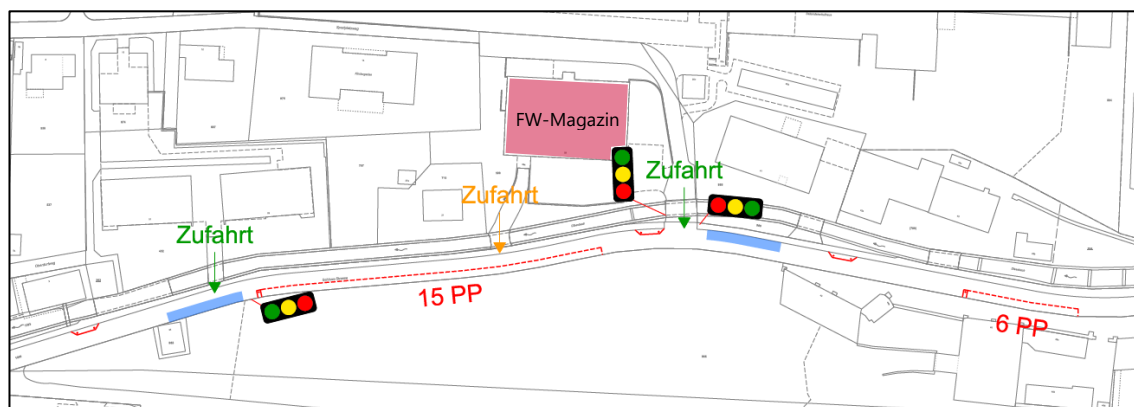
Situation Feuerwehr-Parkierung Variante 1
